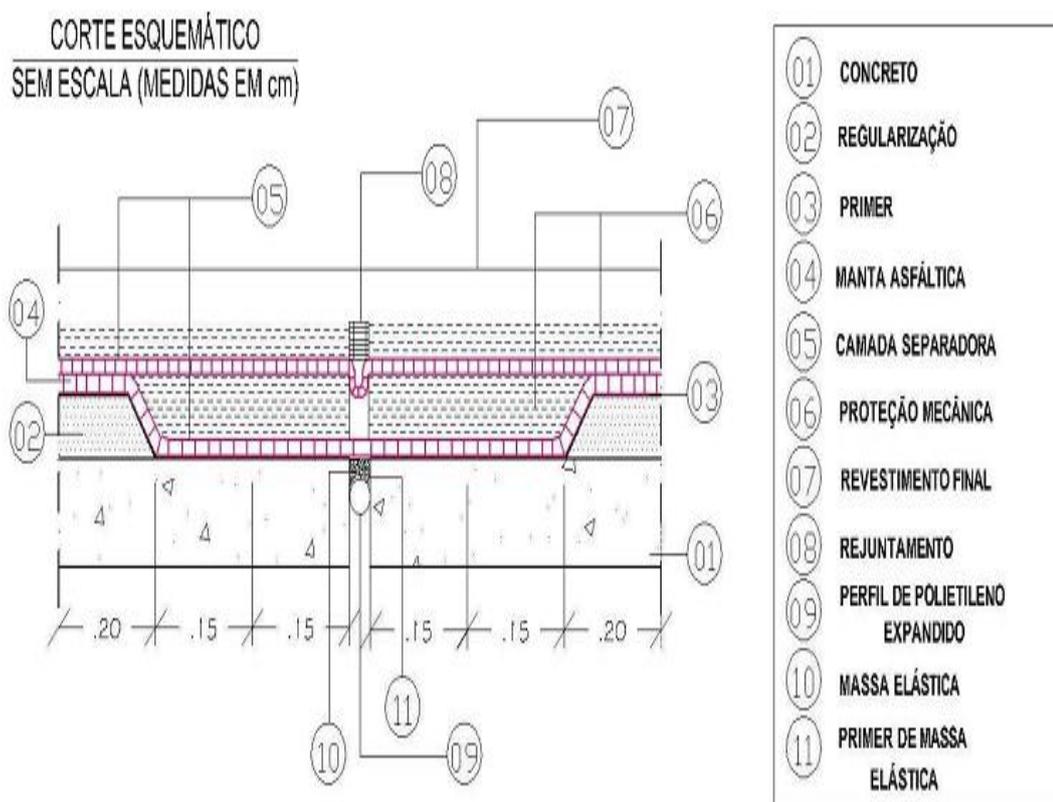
Detalhe de impermeabilização em junta de dilatação – Fonte: Cetimper
